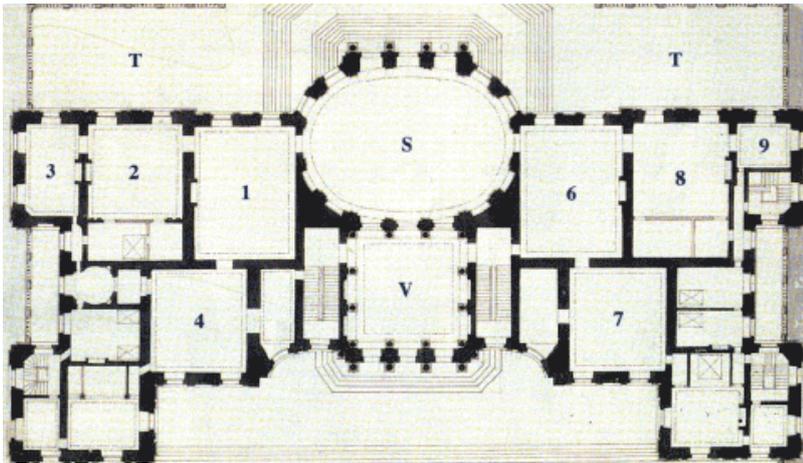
Vaux-le-Vicomte, Grundriss Erdgeschoss
